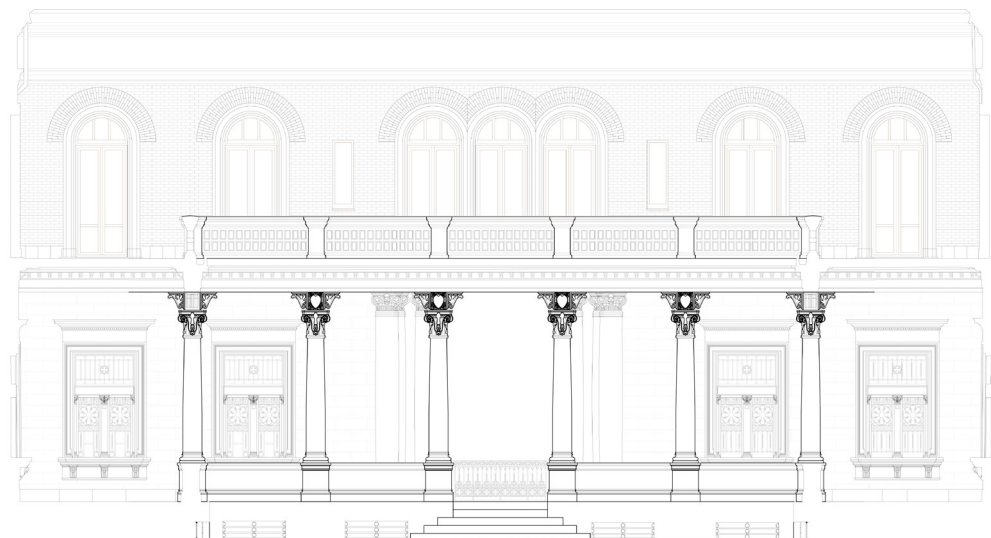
Sezione sul chiostro porticato. Dettaglio di cambio delle colonne della corte (primo piano) ed ambulacro. Elaborazione grafica dell'autore.
